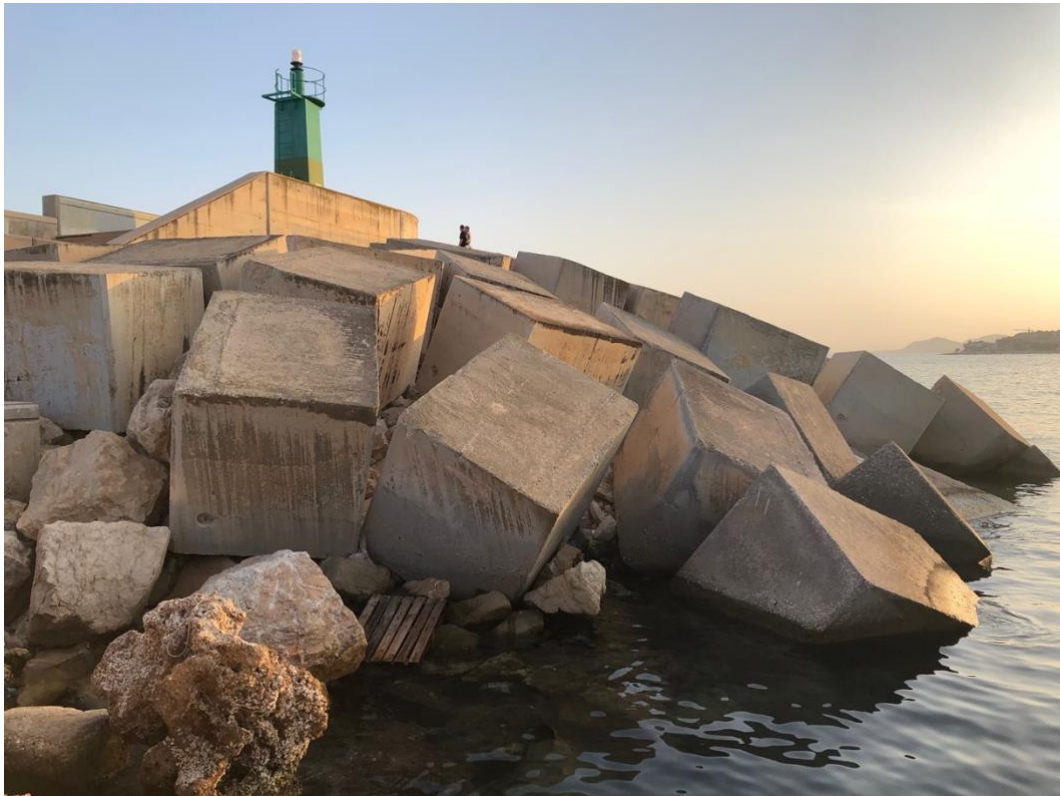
Vista del morro del dique. Manto de bloques de hormigón.
